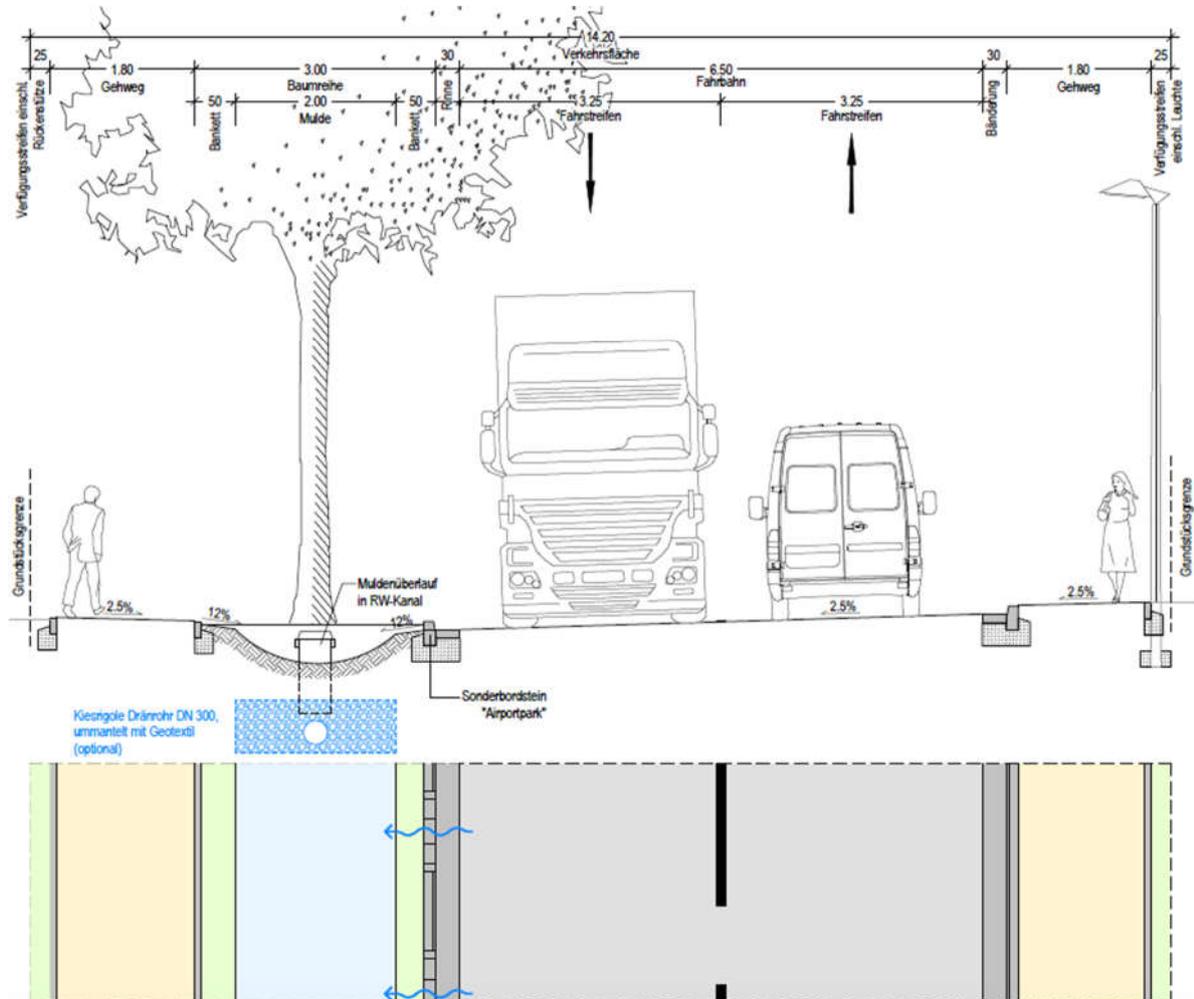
Regelquerschnitt Planstraße E; Planungsbüro Hahm Januar 2022
